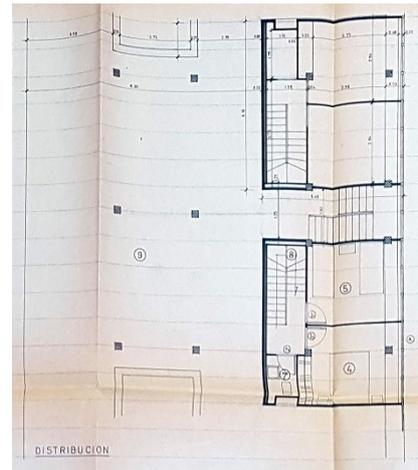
Planta baja dúplex Distribución B-2-4. 1964. Fuente: Archivo Municipal da Coruña
